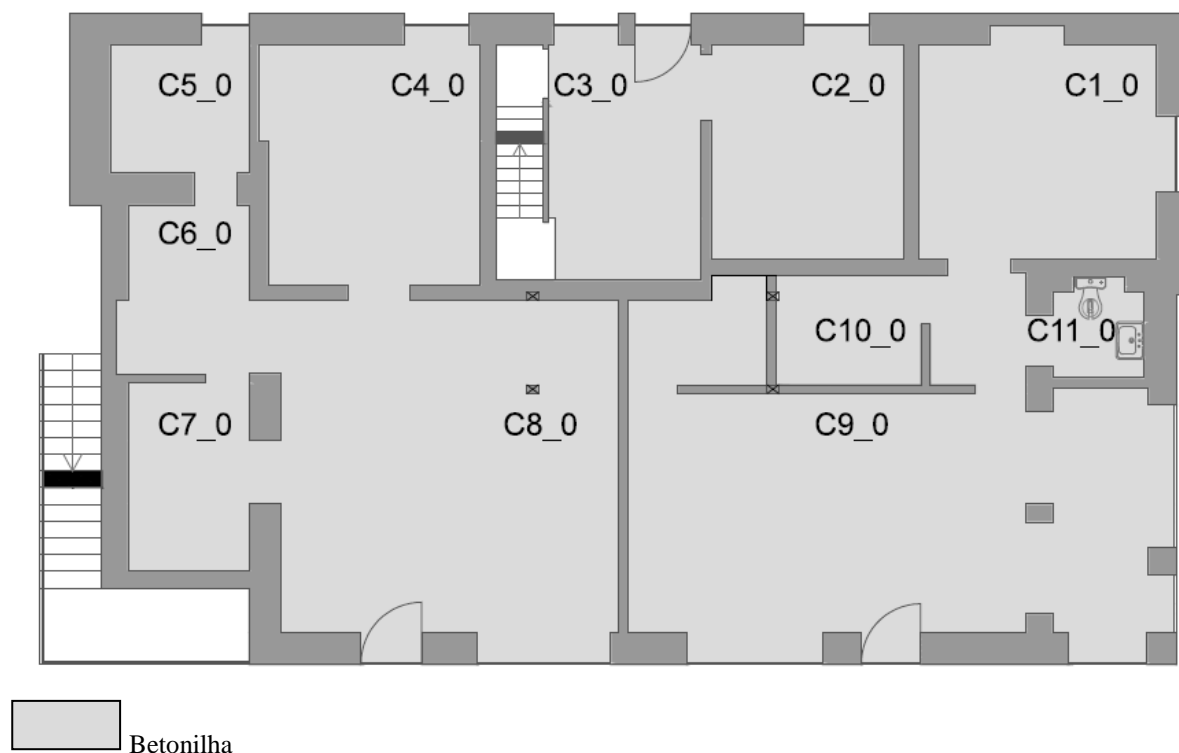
Planta com representação da estrutura do pavimento. Piso térreo
